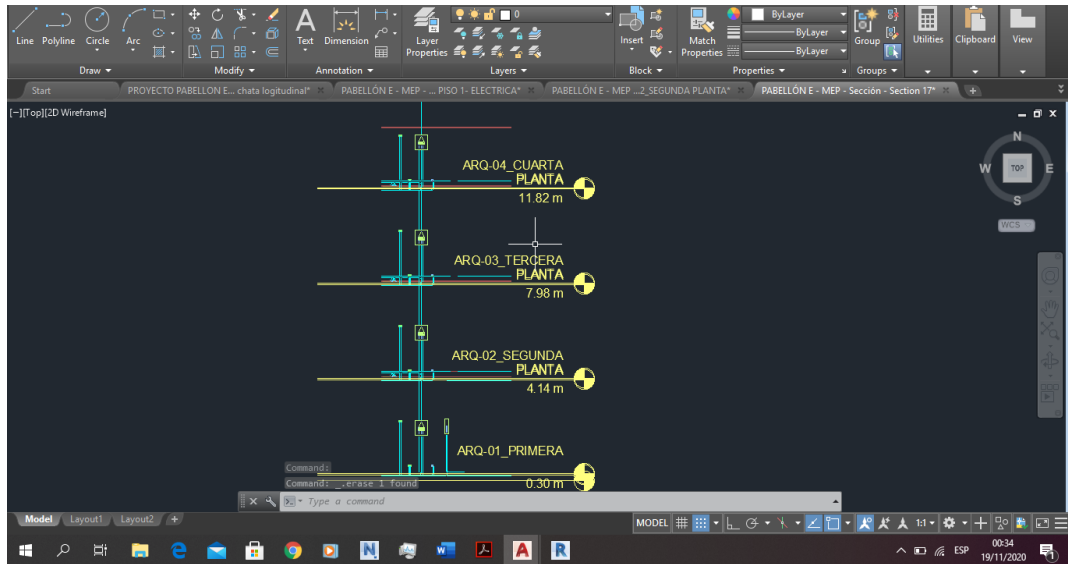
Diseño de Instalaciones Eléctricas-Vista sección con AutoCAD
